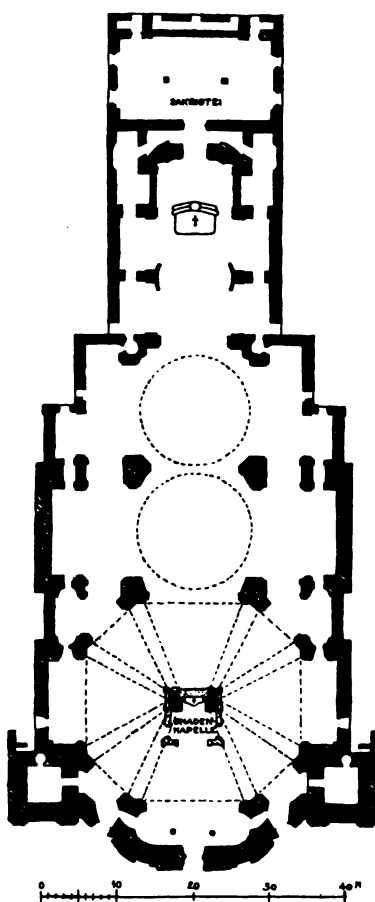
Einsiedeln, Grundriss 1:1000.
